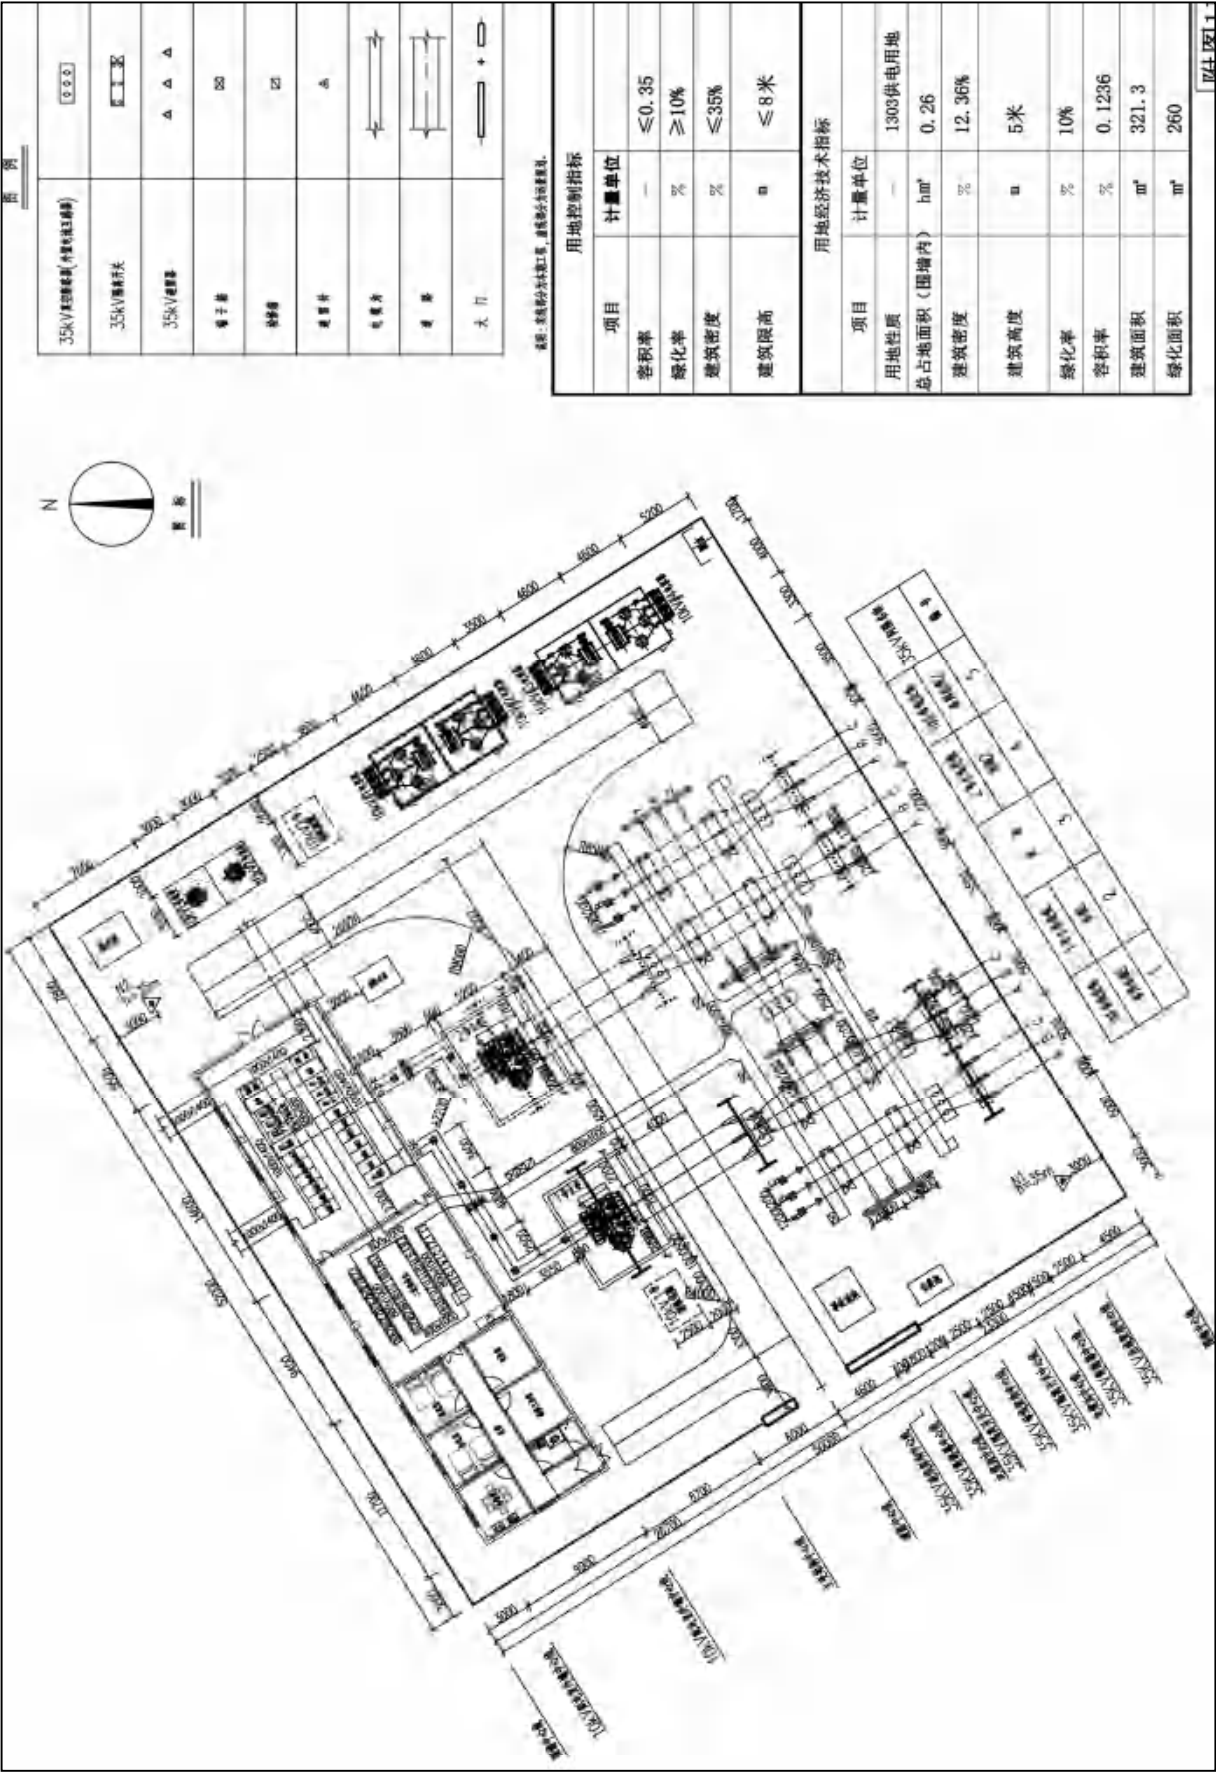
黄介壕 35kV 变电站电气总平面布置图
